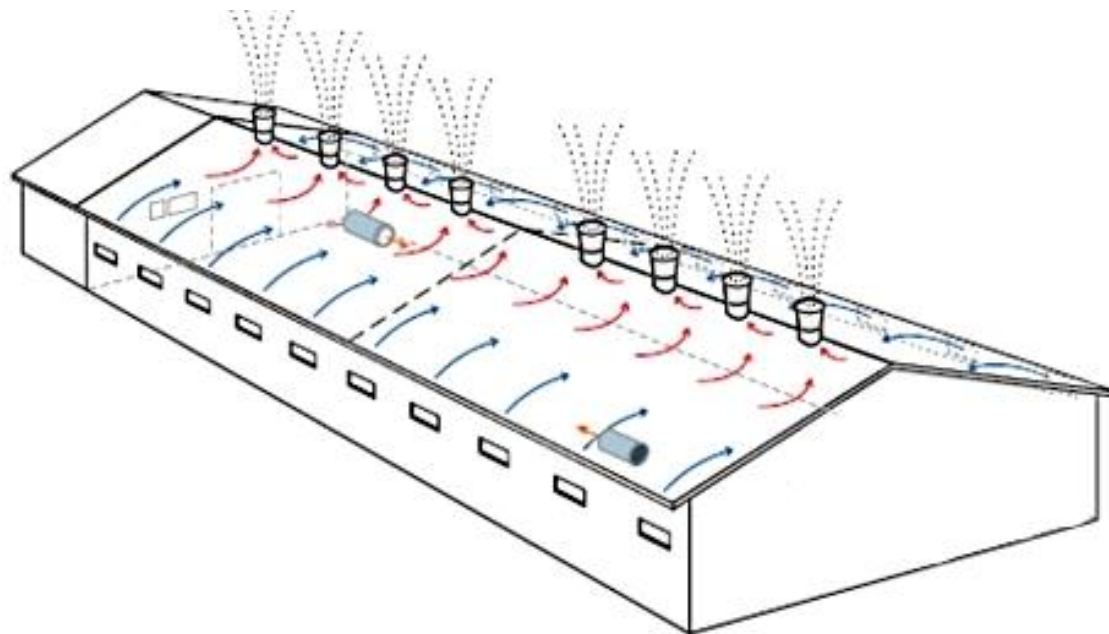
Схема приміщення з поєднаним типом вентиляції
